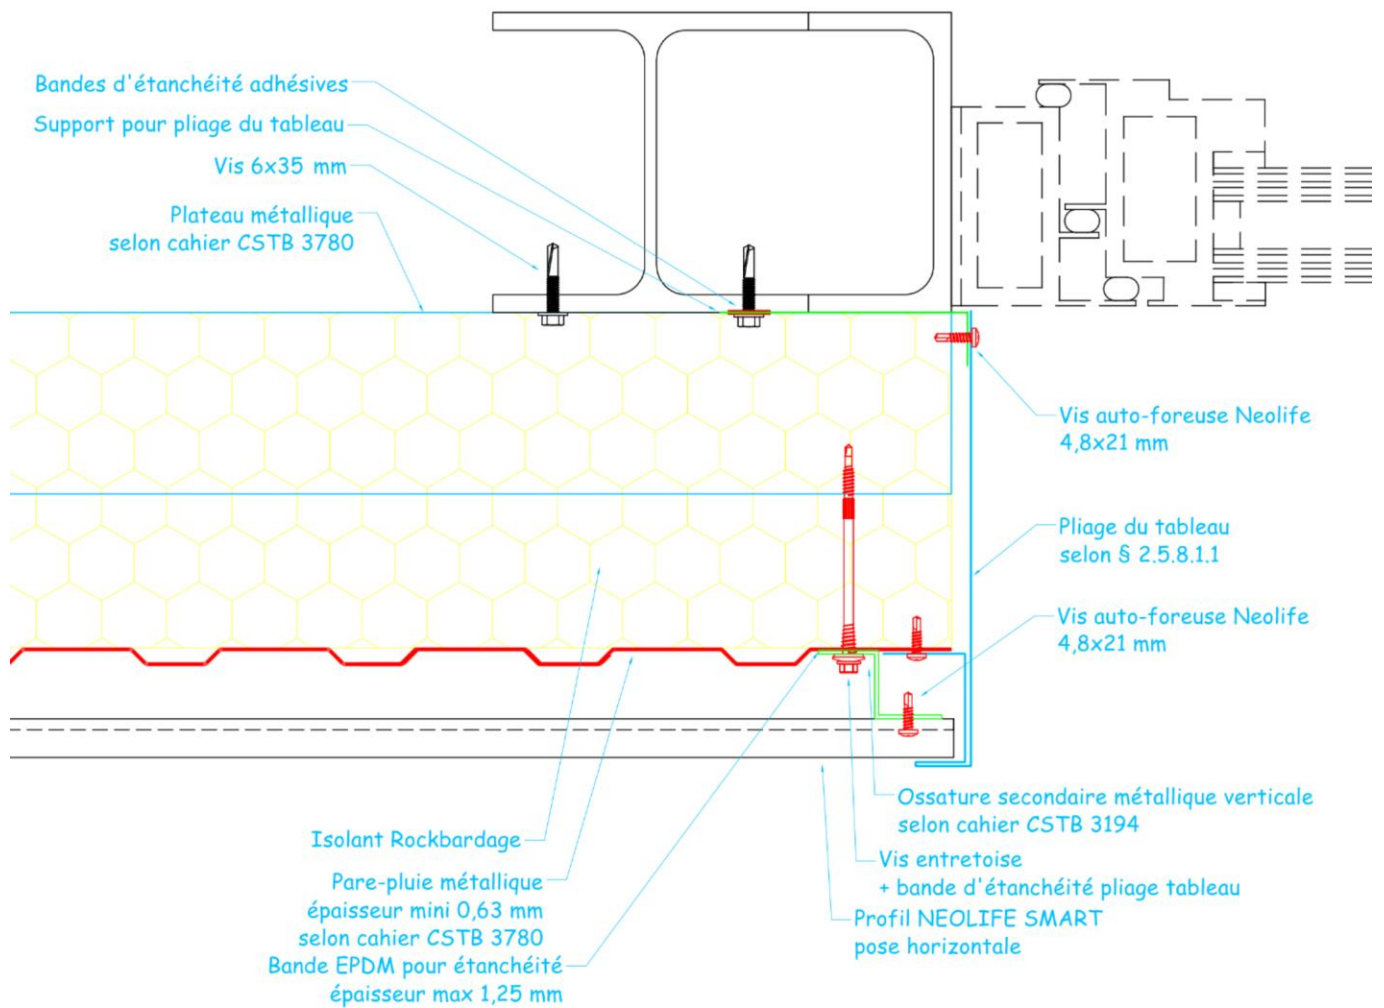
Appui de baie (coupe verticale) – Pose horizontale
